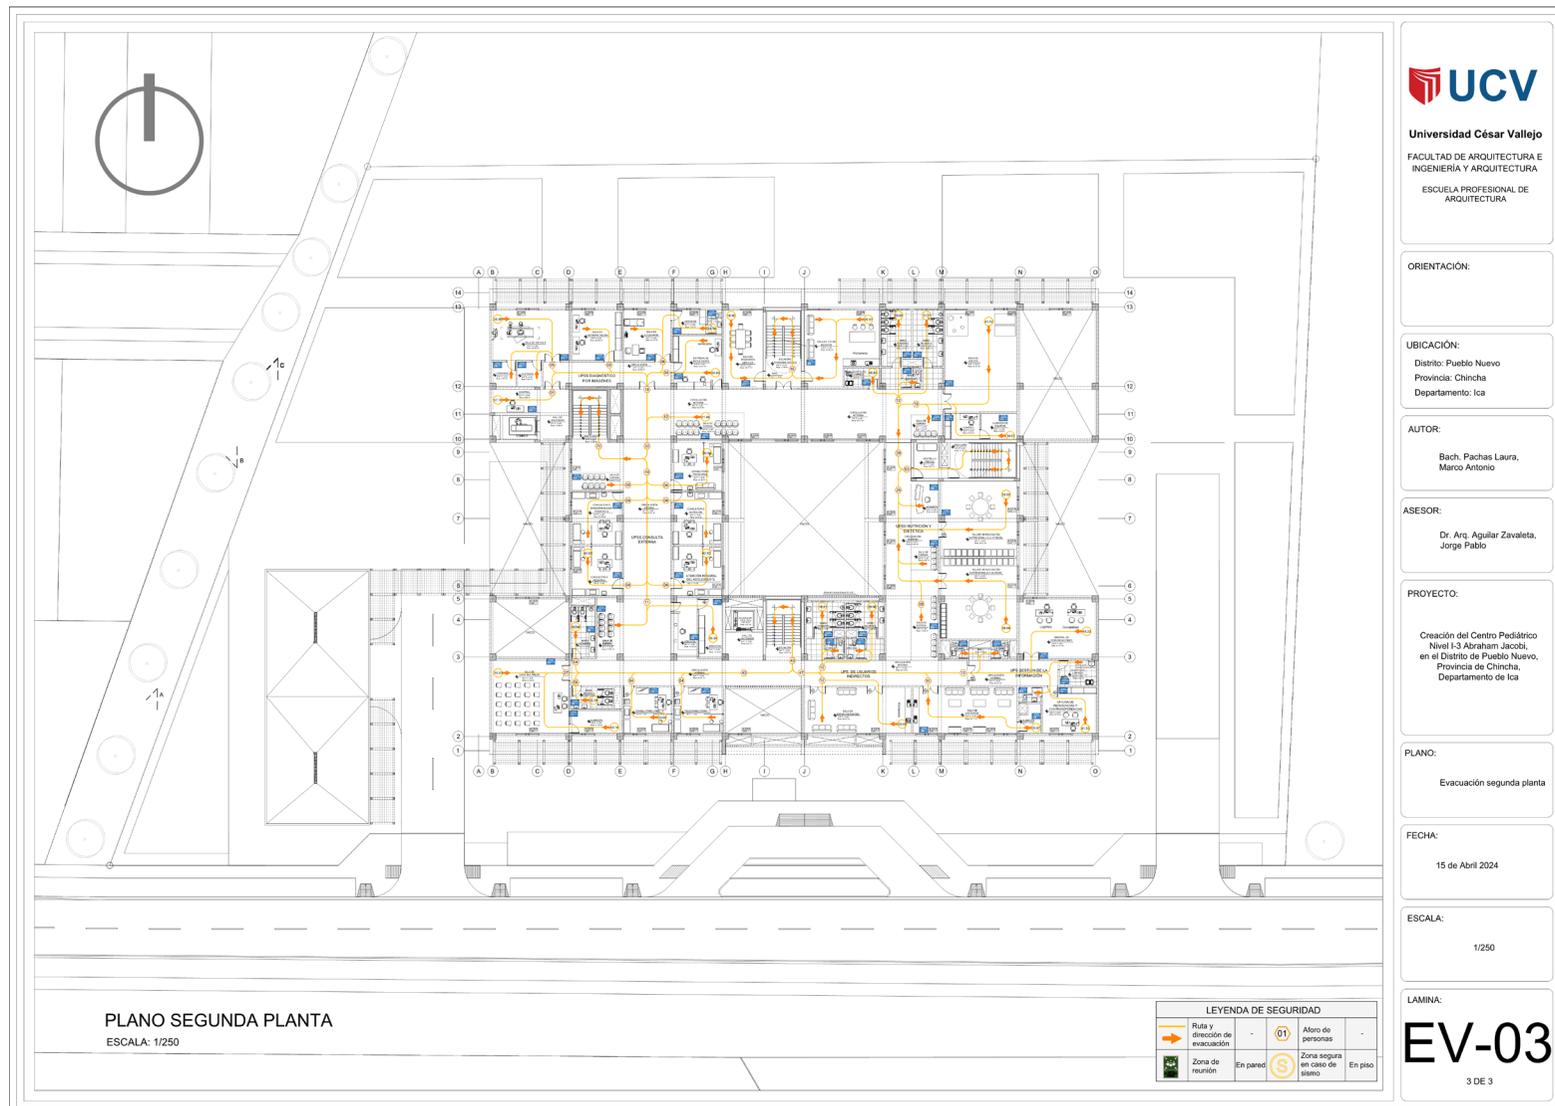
EV-03 Plano de evacuación 2° planta. Fuente: Elaboración propia.
